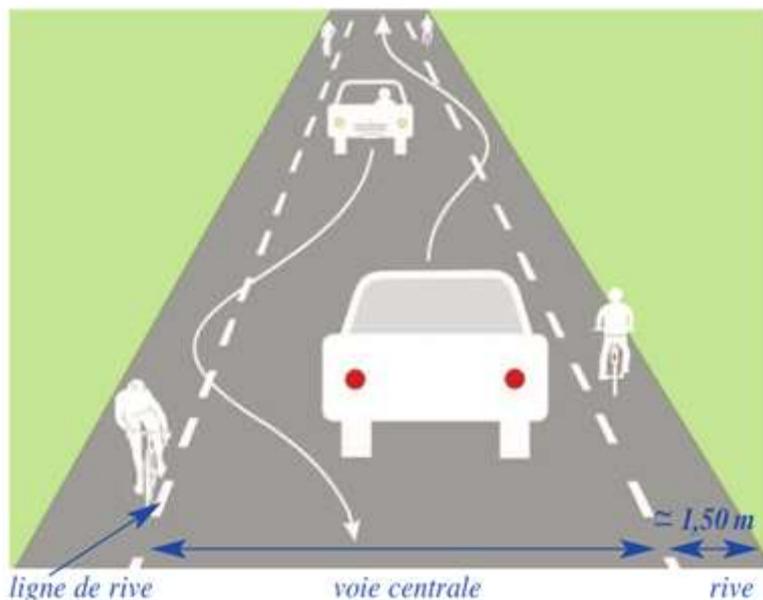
Chaussée à voie centrale banalisée (Source : CEREMA, 2015a)
